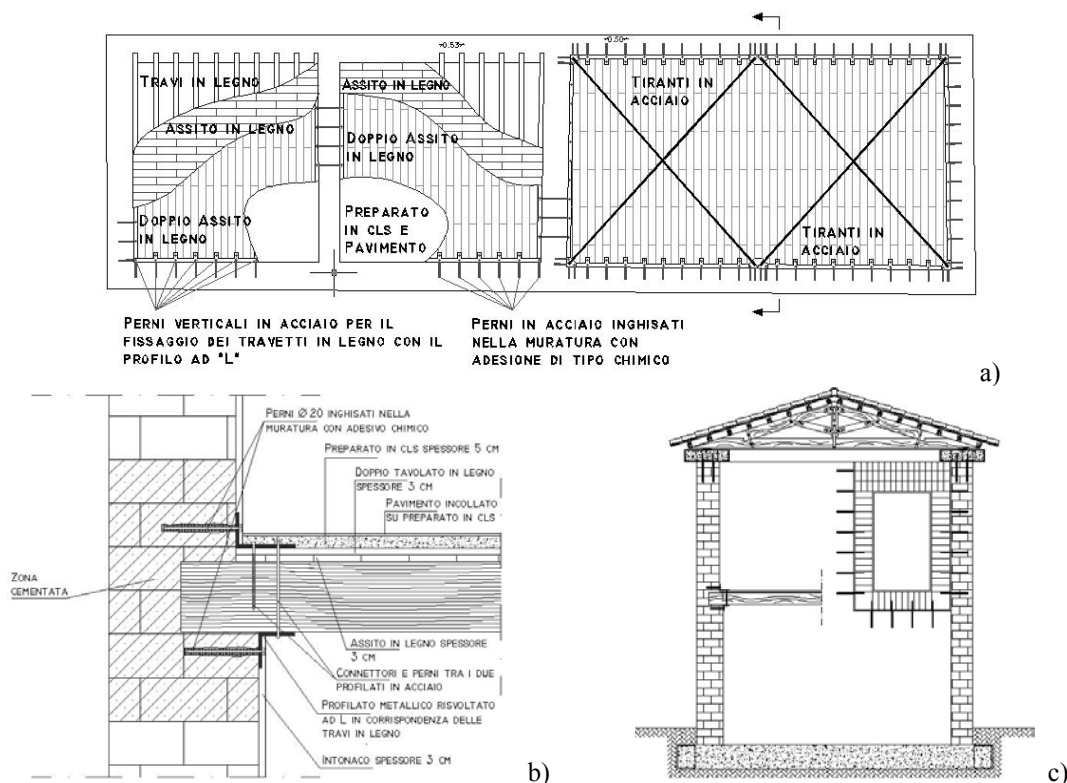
a) Pianta solaio di primo impalcato; b) Particolare collegamento solaio con le strutture verticali; c) Sezione trasversale.
